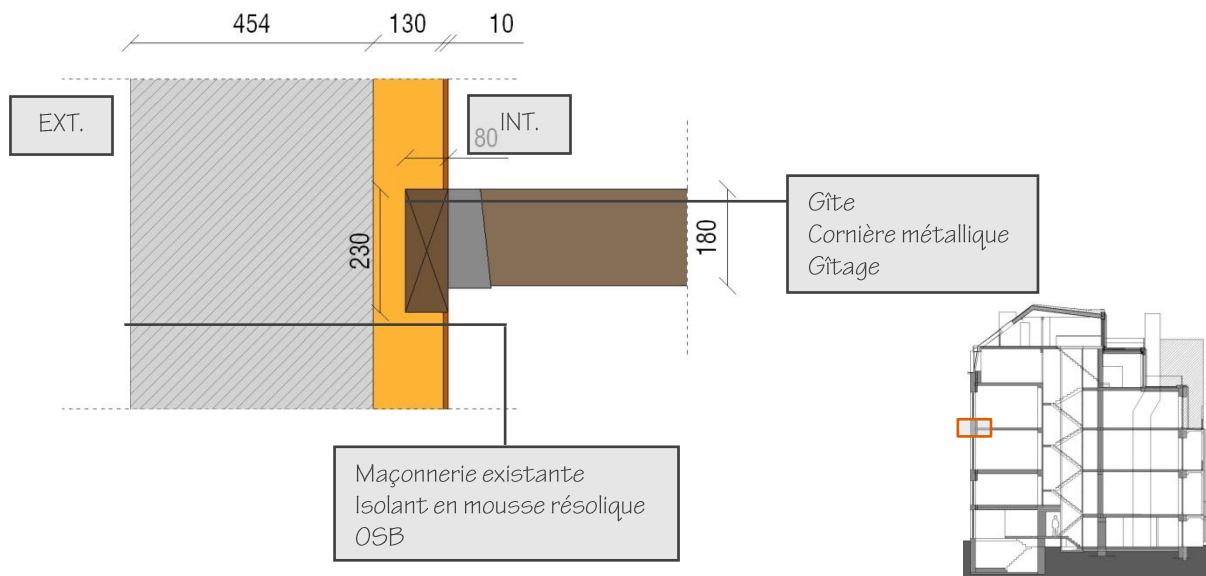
Détail de l'isolation par l'intérieur de la façade avant au droit du plancher, mesures en [mm]
